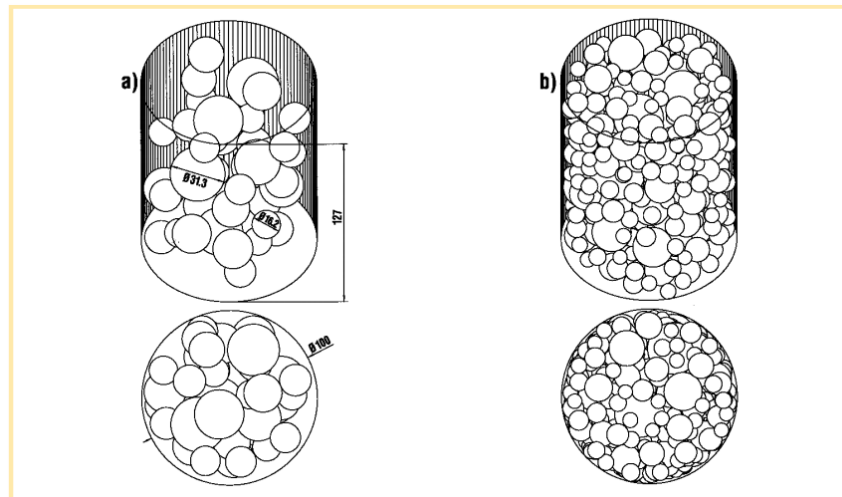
Distribución de los áridos sobre la tubería de bombeo de hormigón. Fuente: [2]
